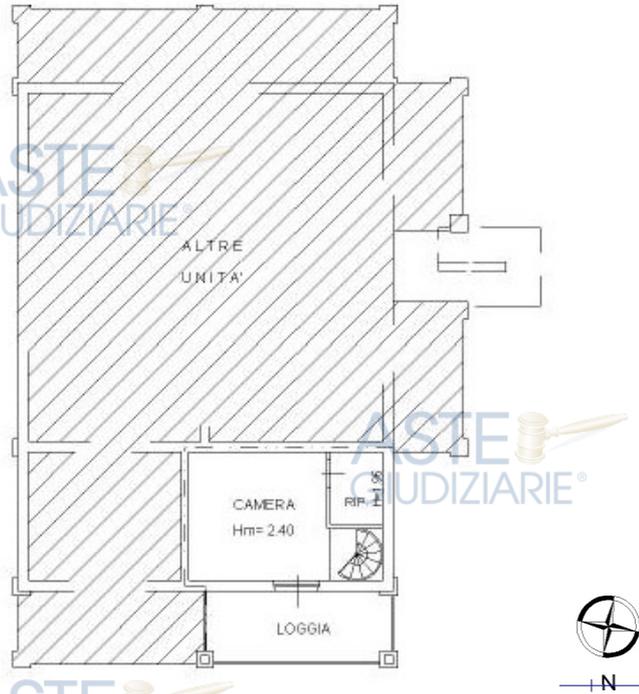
Stralcio planimetria appartamento – NCT Fg.4 particella 370 sub. 1
